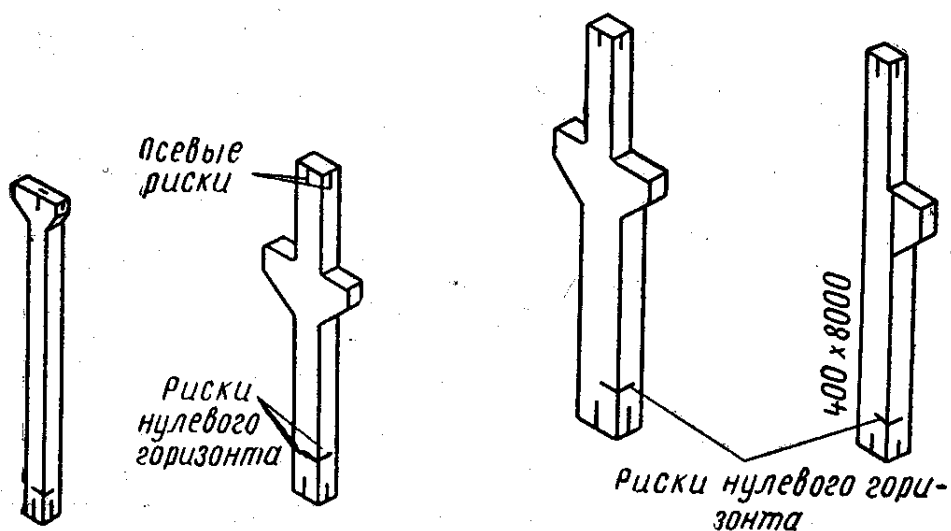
Нанесение рисков при монтаже железобетонных колонн
